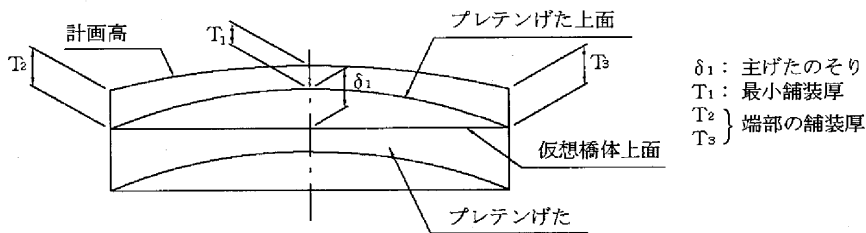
舗装面が凸の場合で、桁の曲率<舗装面の曲率の場合
